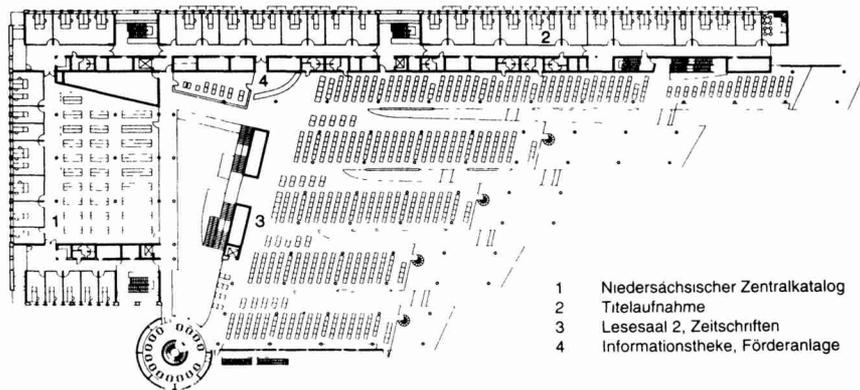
SUB-Grundriß, 2. Obergeschoß
